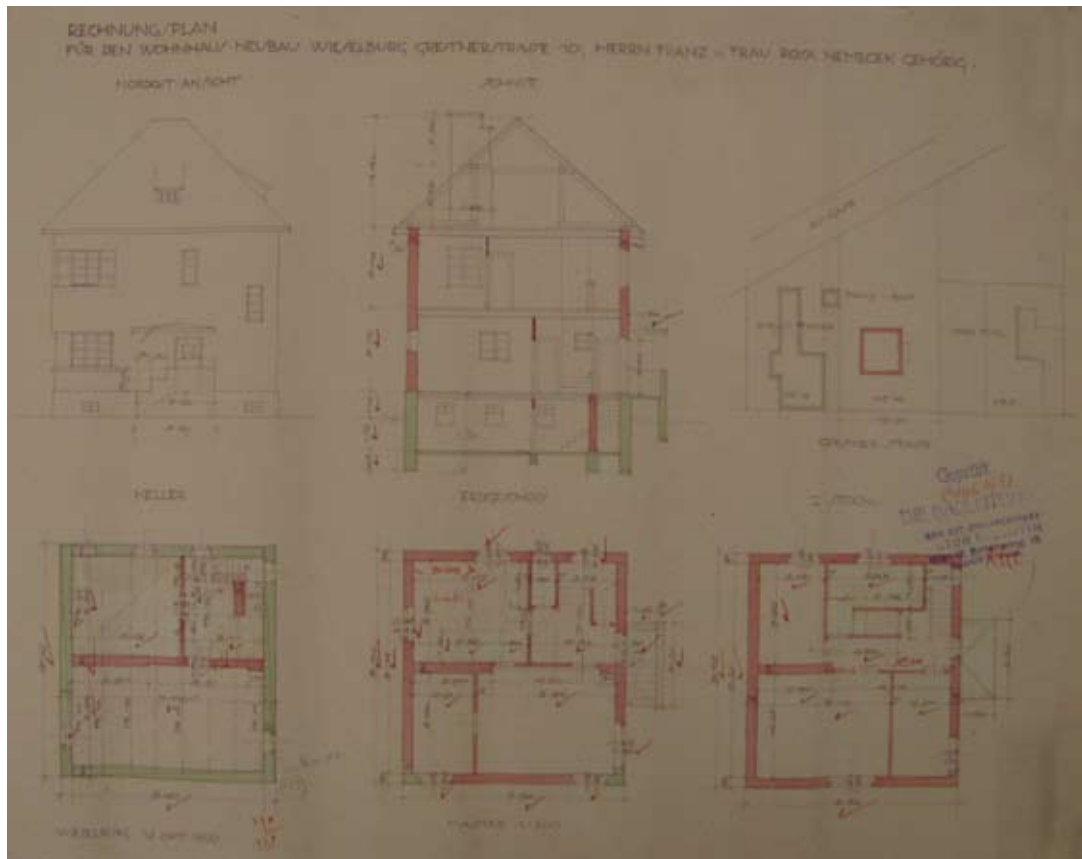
Plan 16.10: Anton Valentin. Rechnungsplan für den Wohnhaus-Neubau Wieselburg, Grestnerstraße 10, Herrn Franz u. Frau Rosa Nemecek gehörig. Ansicht, Schnitt, Grundrisse, Lageplan. 12. Oktober 1932.
